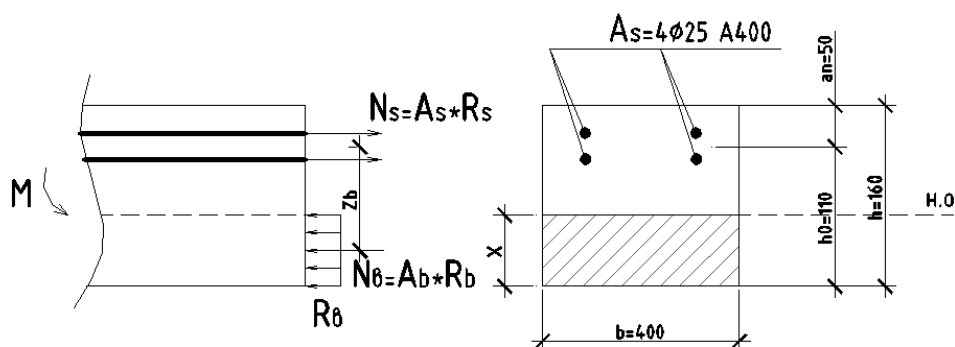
Схема внутренних усилий мнимой главной балки на опоре
